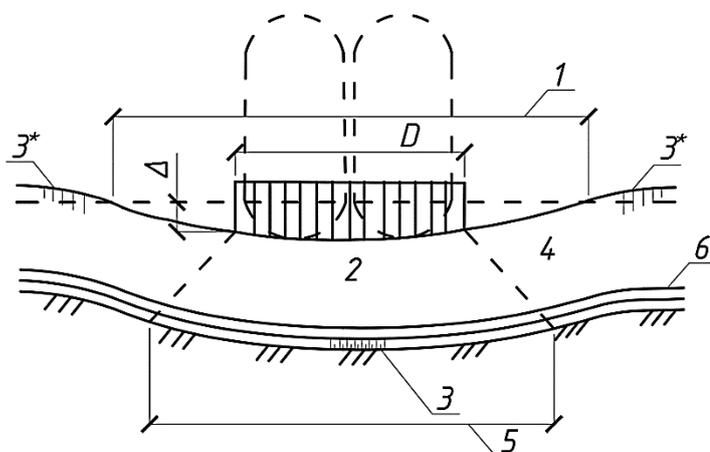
Влияние различных методов армирования покрытия на разрушение нежестких дорожных одежд под воздействием подвижной нагрузки:
